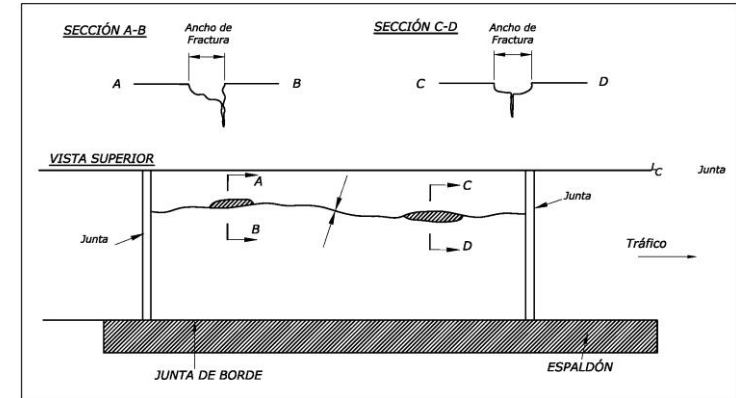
Esquema Grieta Longitudinal- Pavimento Rígido
